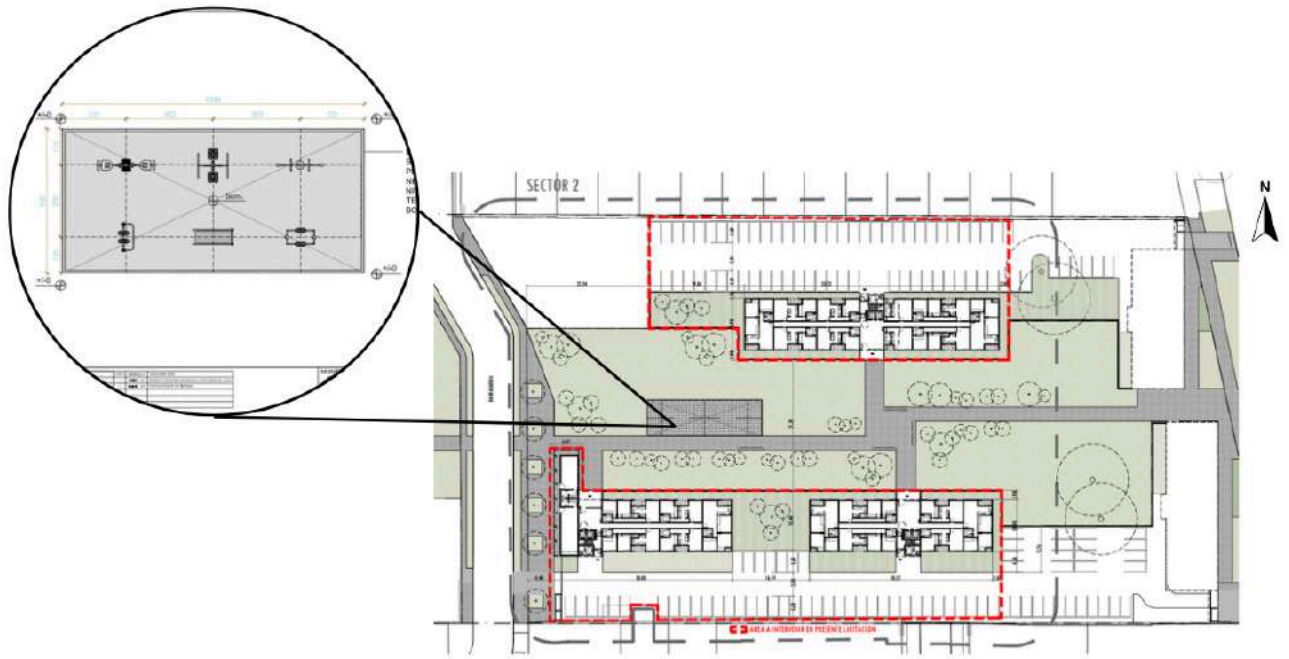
Ubicación de la estación deportiva original - Fuente: Anteproyecto - “PLANTA GRAL. SECTOR II”
